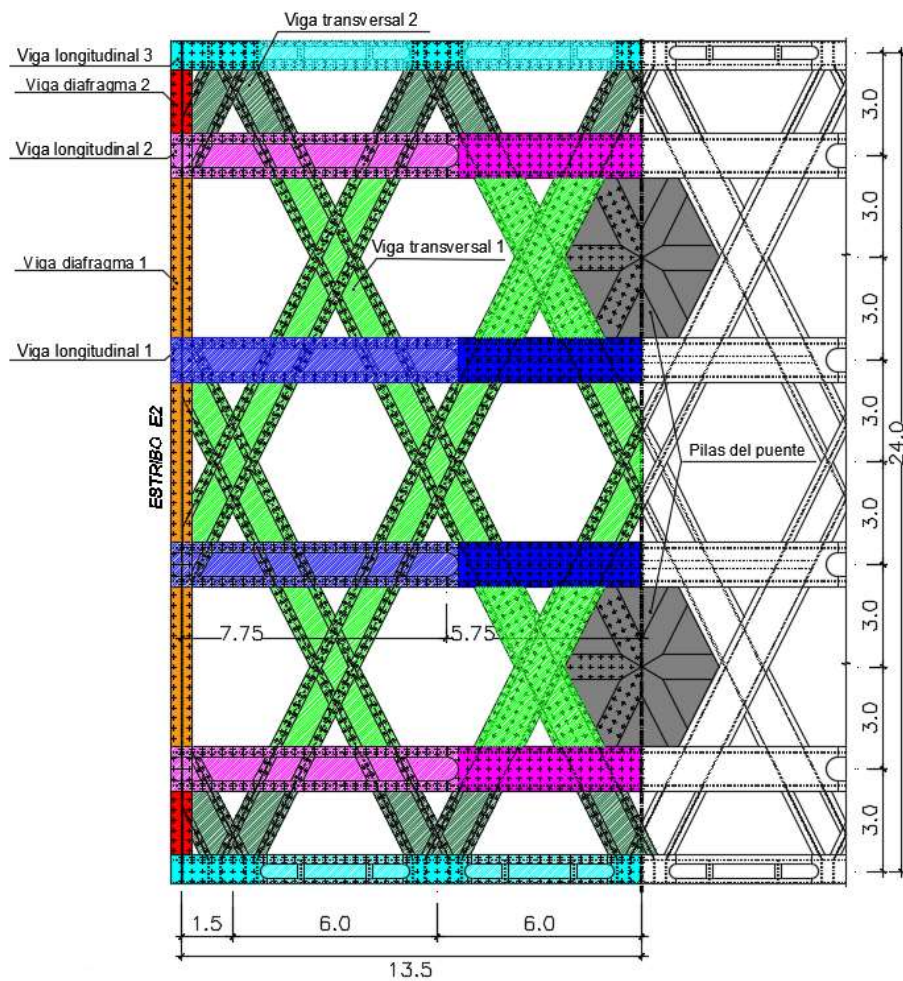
Planta de la zona afectada por el incendio. Cotas en m.
